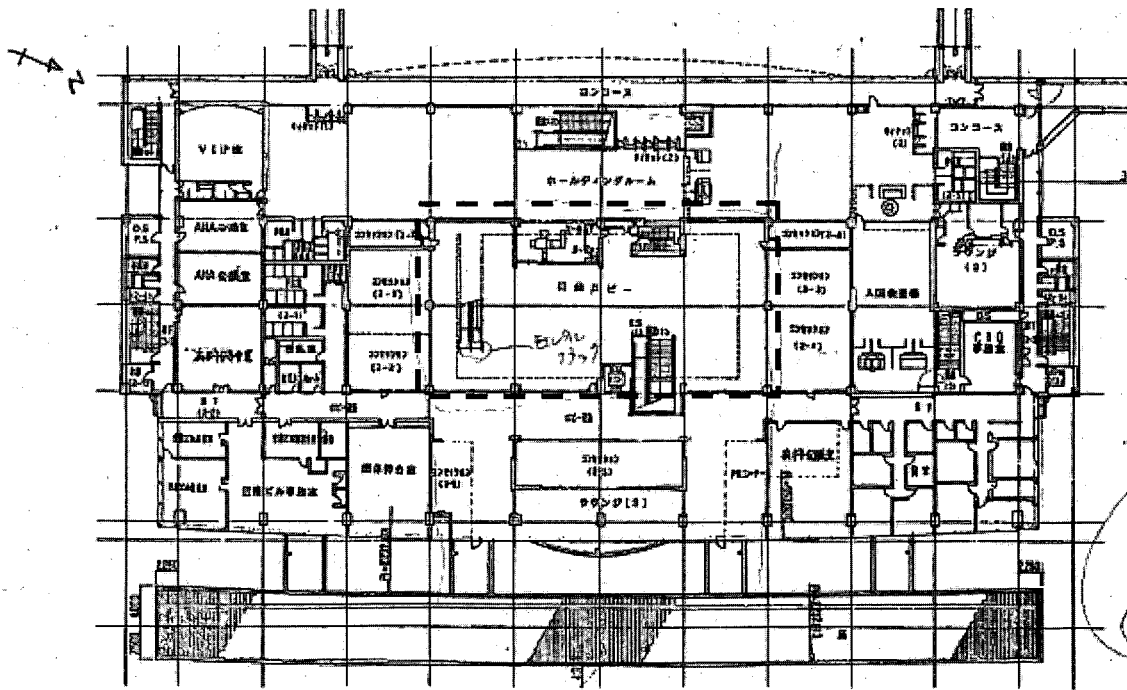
2階平面図 (調査当日の配布資料^{※3}より)
